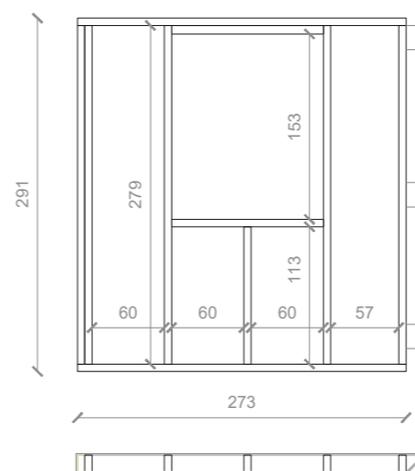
Prospetto quotato chiusura verticale prefabbricata 05B
